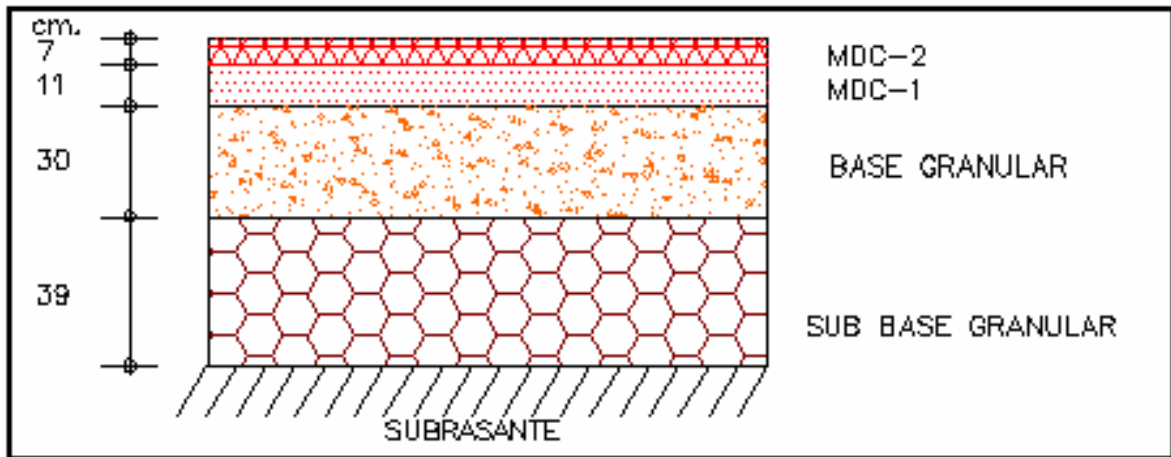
Estructura de Pavimento K10+100-K12+543 Oriental
